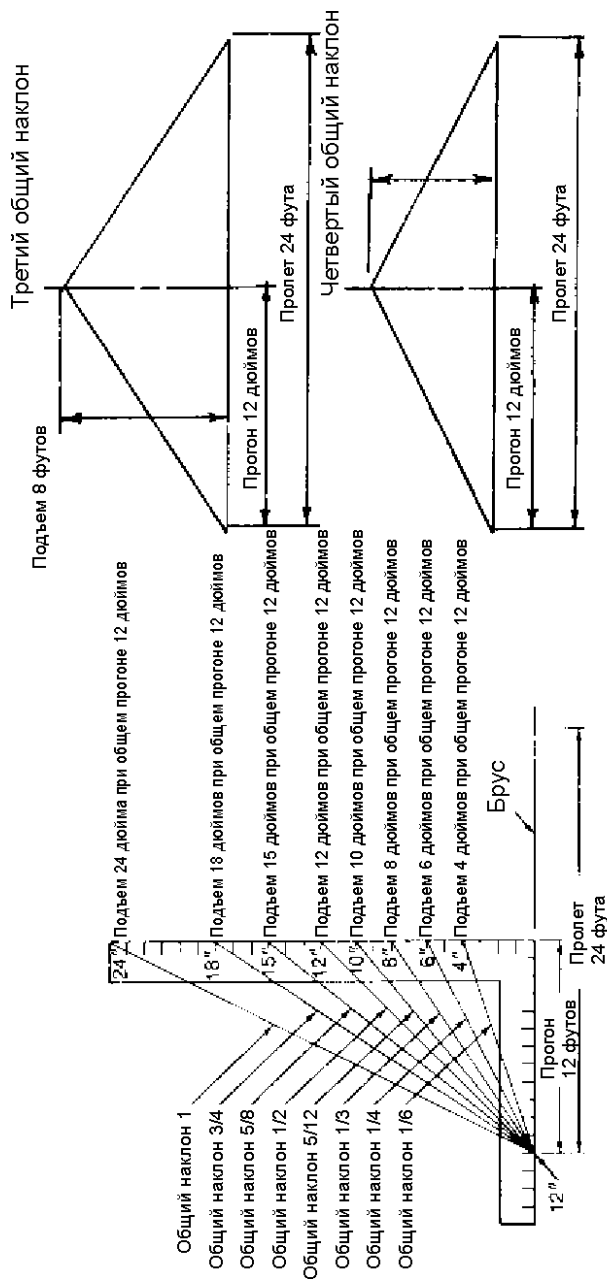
Стандартные общие наклоны скатов крыши (Stanley Tools)
